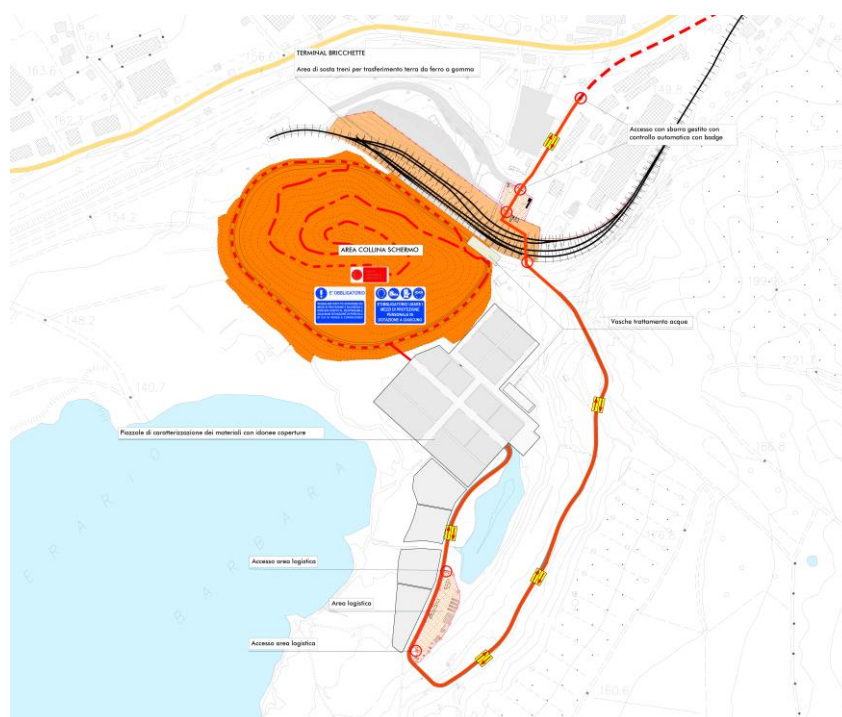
Stralcio planimetrico dell'area di cantiere di S.Barbara
